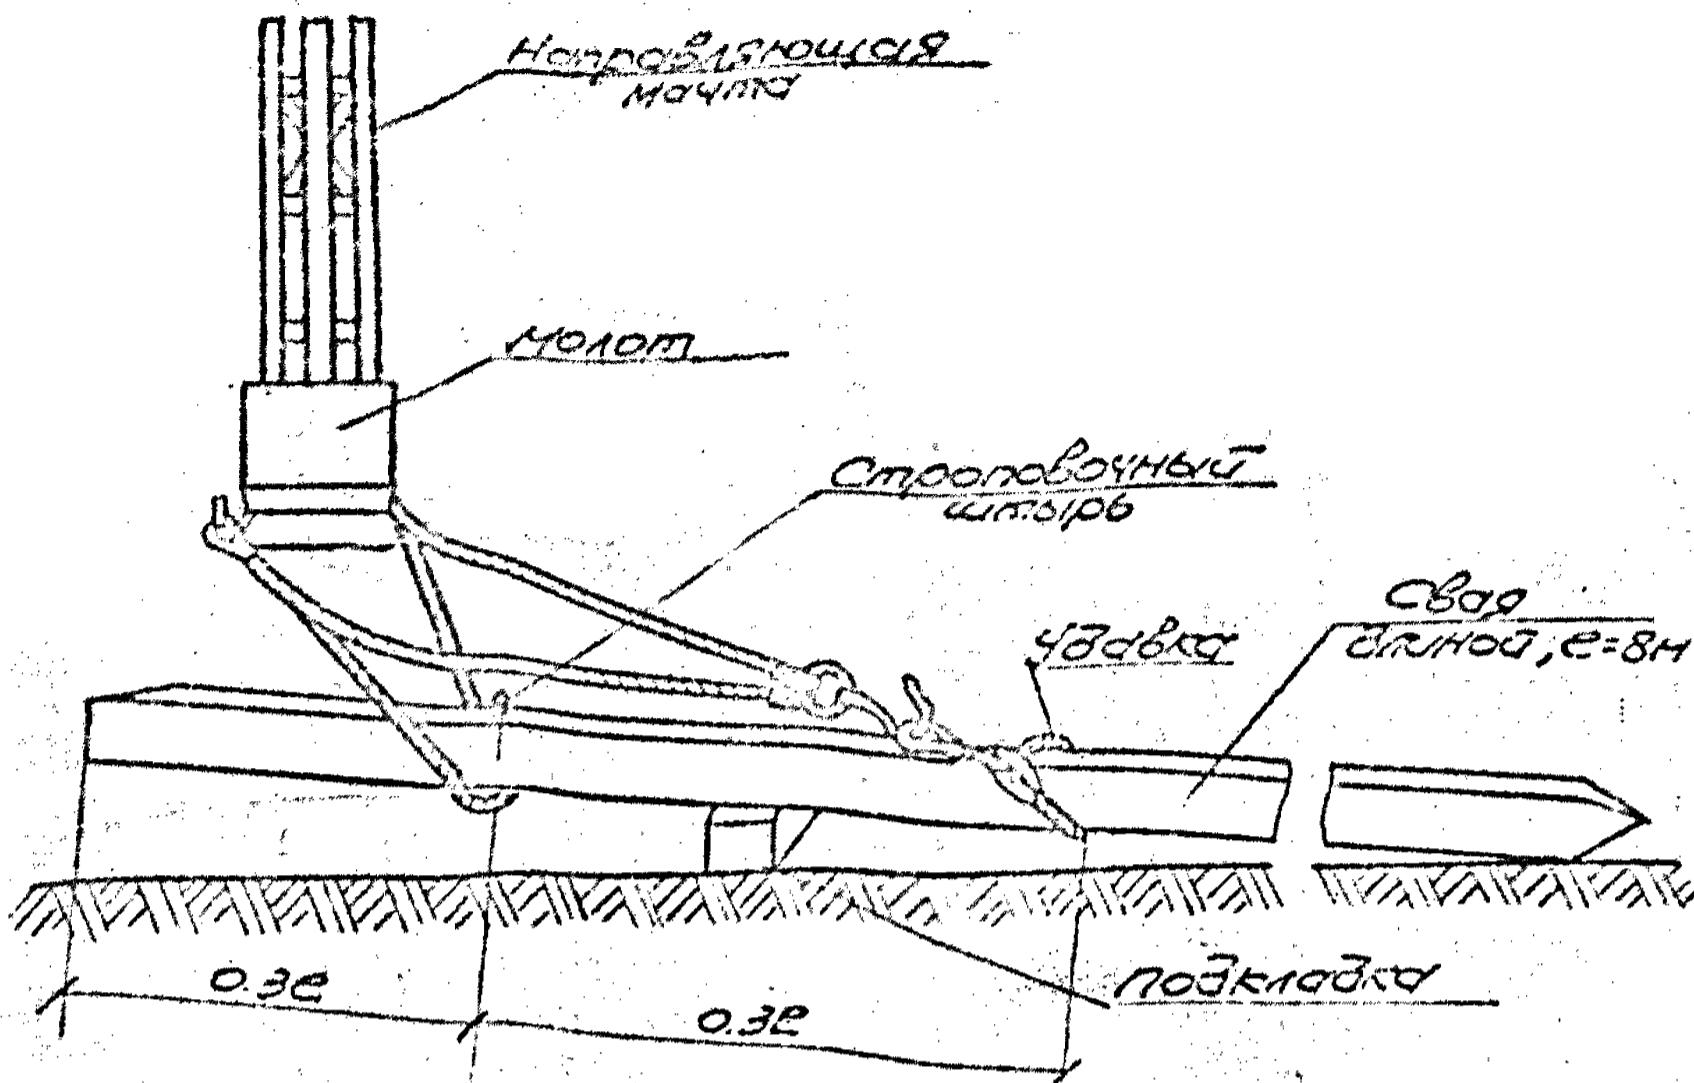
Зоводка сваи в оголовник для зоводки копром
